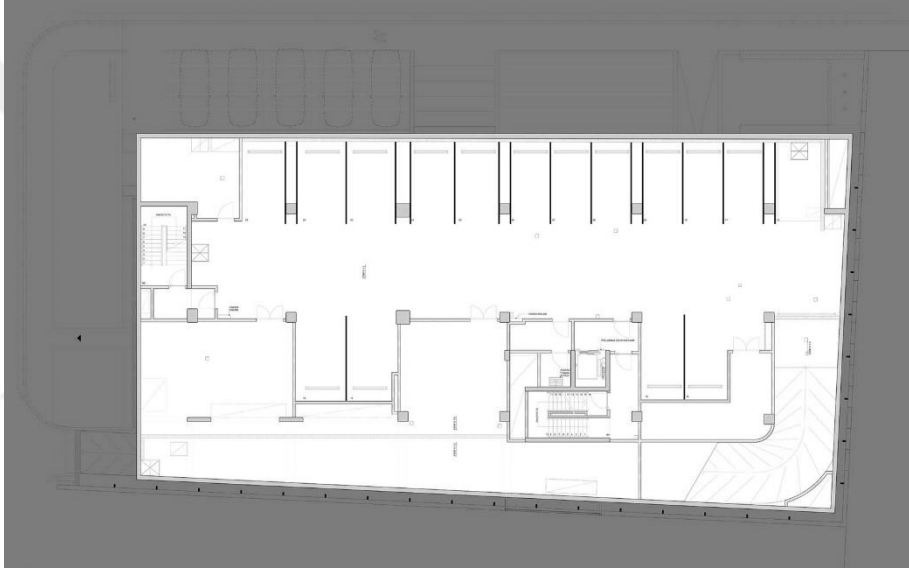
TMB Genel Merkez Binası üçüncü kat planı [70]
